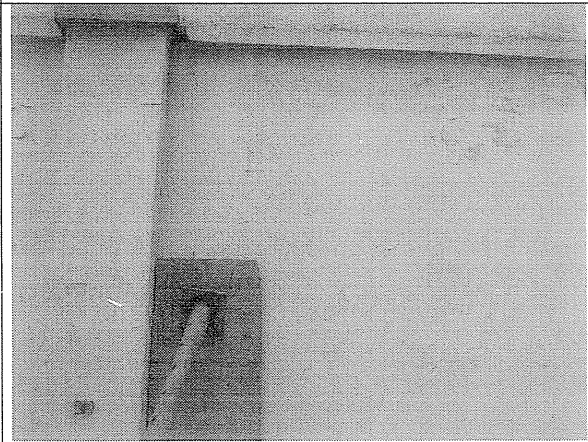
Fisuras en muro de lindero de la parte posterior, costado occidental.
